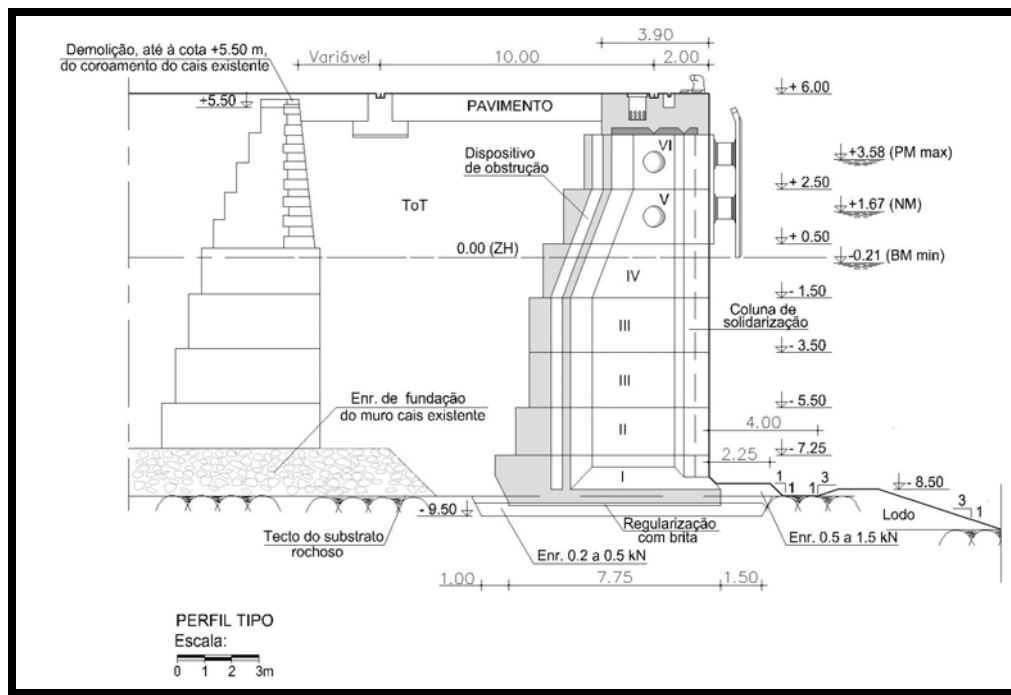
a) – Corte tipo do muro-cais em Blocos NOREF
